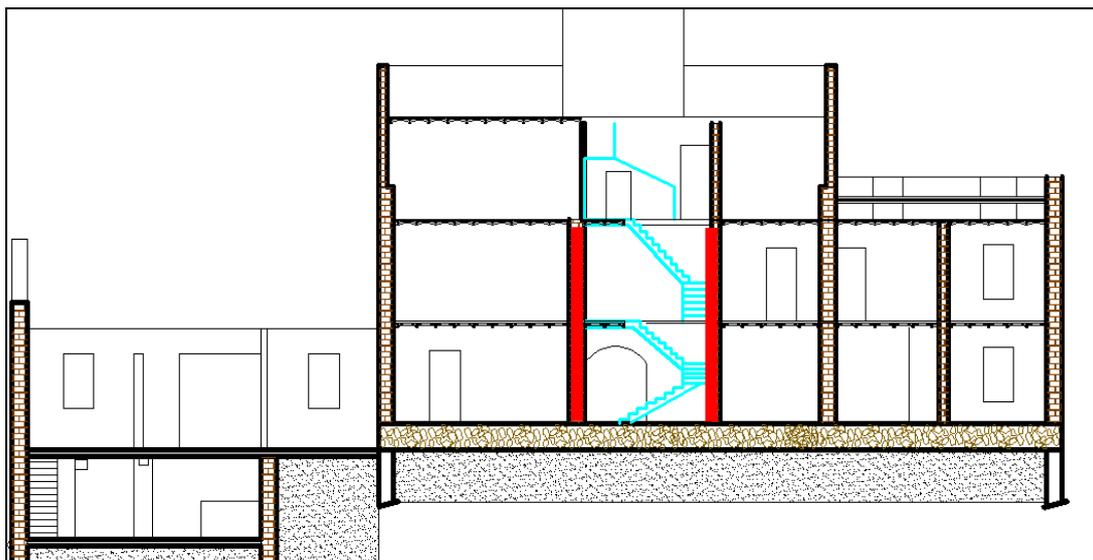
, coupe longitudinale sur le bâtiment, source : Ep
